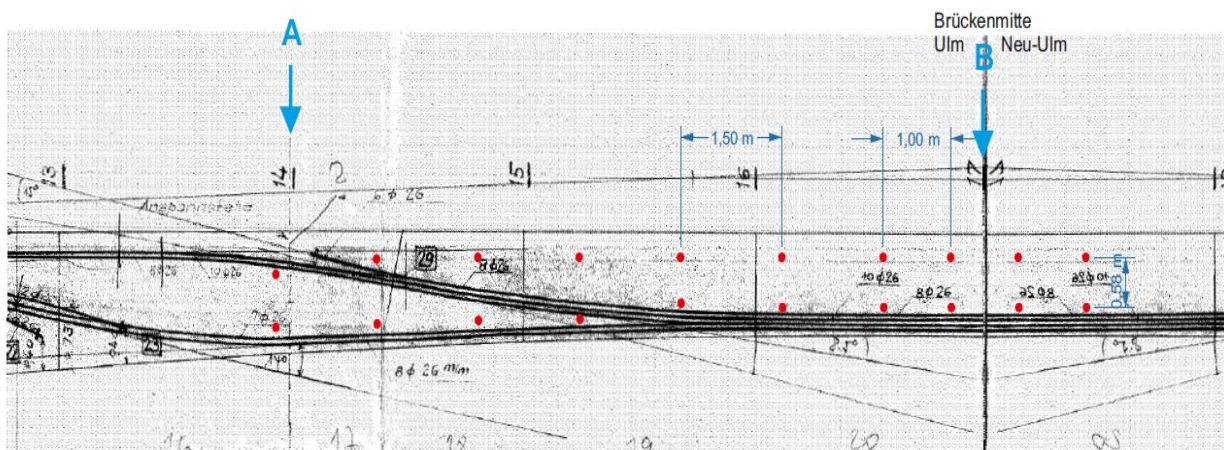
Sensorpositionen nach Einbau mit Spannkanalverlauf (Unterlagen Ingenieurbüro Schiessl)
